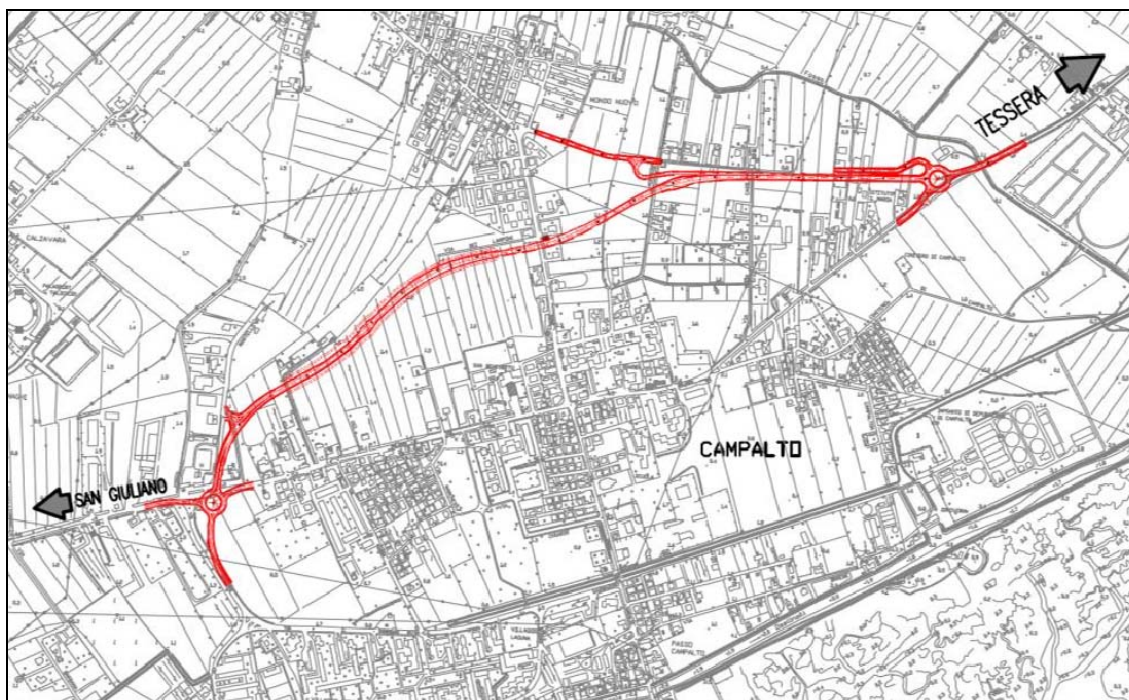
Stralcio planimetrico Opere di progetto – (Fonte: Piano di Monitoraggio Ambientale)
